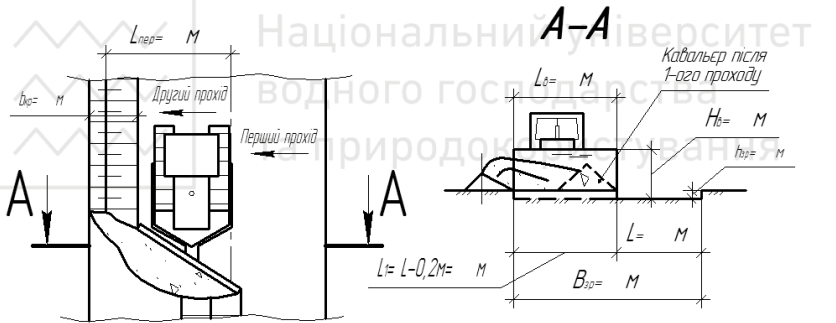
Схема зрізки рослинного шару ґрунту за повздовжньою схемою
